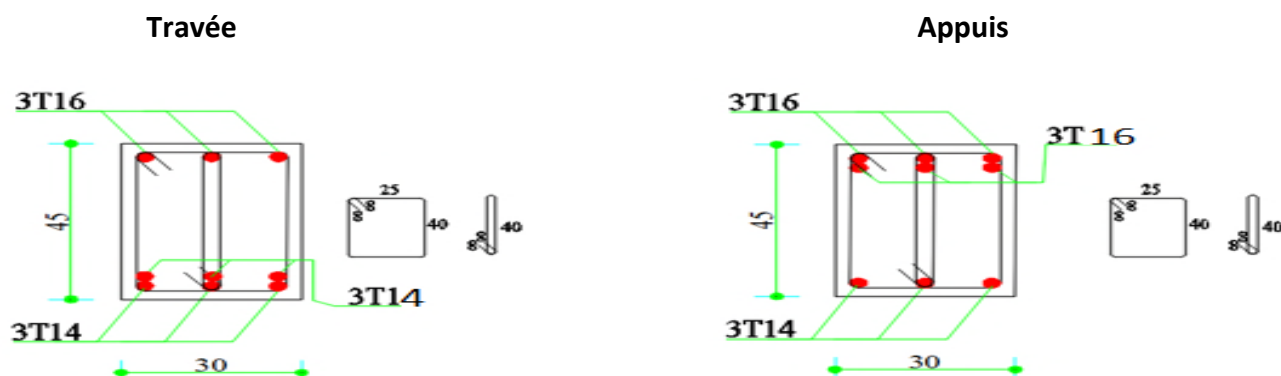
Schéma de ferrailage de la poutre principale de ES1-2
